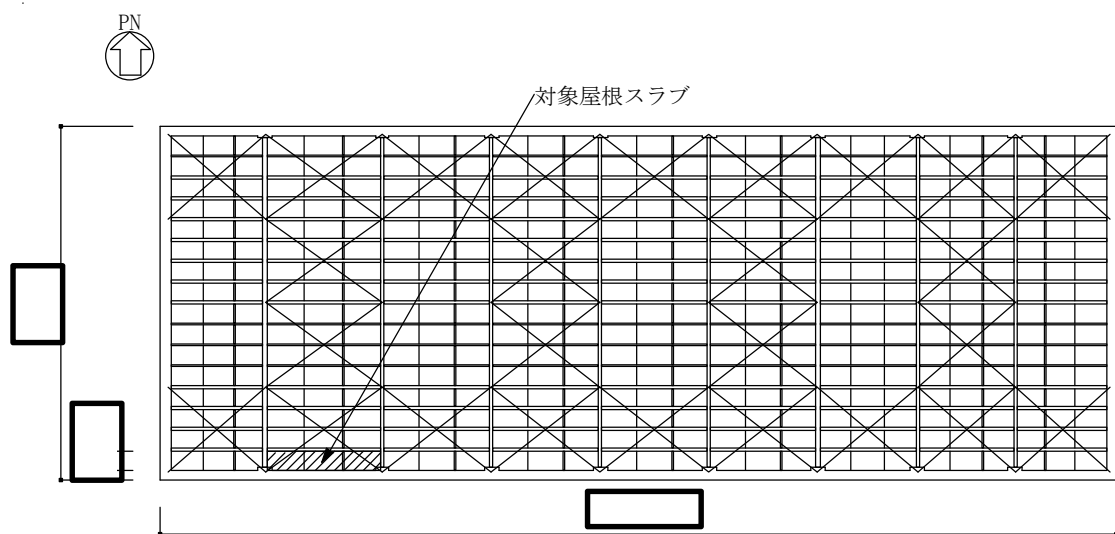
屋根スラブ評価部材の位置 (主トラス上 : EL. 40.45 m)
